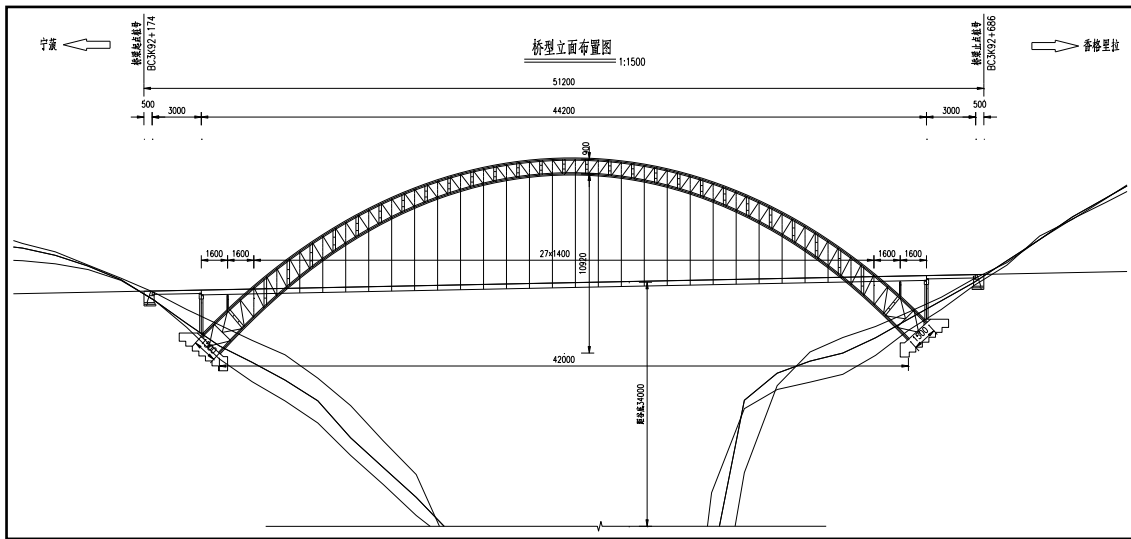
典型桥梁示意图（洛吉河特大桥）---中承式钢管混凝土拱
